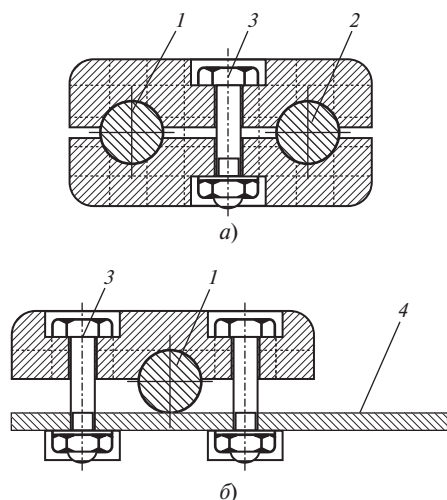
Примеры выполнения соединений между стержнем арматуры и проводом:
